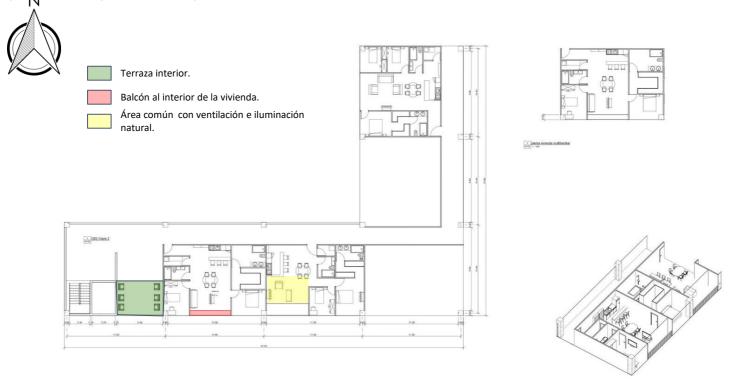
Primer propuesta de diseño. Plantas e isométrico. Elaboración propia. 2022
